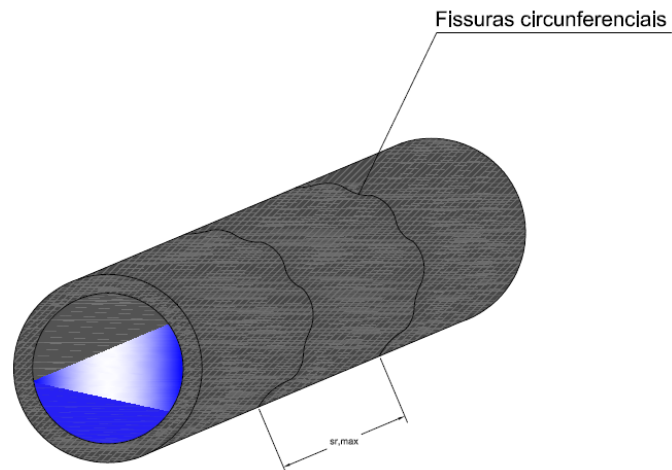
Padrão de fissuras presentes no trecho de restituição.
